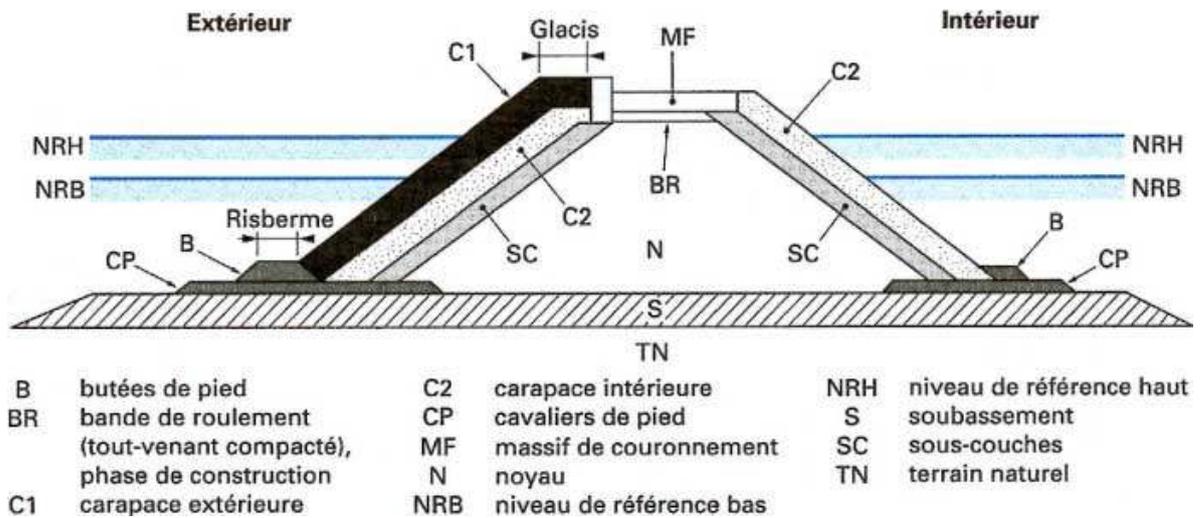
Coupe type d'une digue à talus : éléments constitutifs
